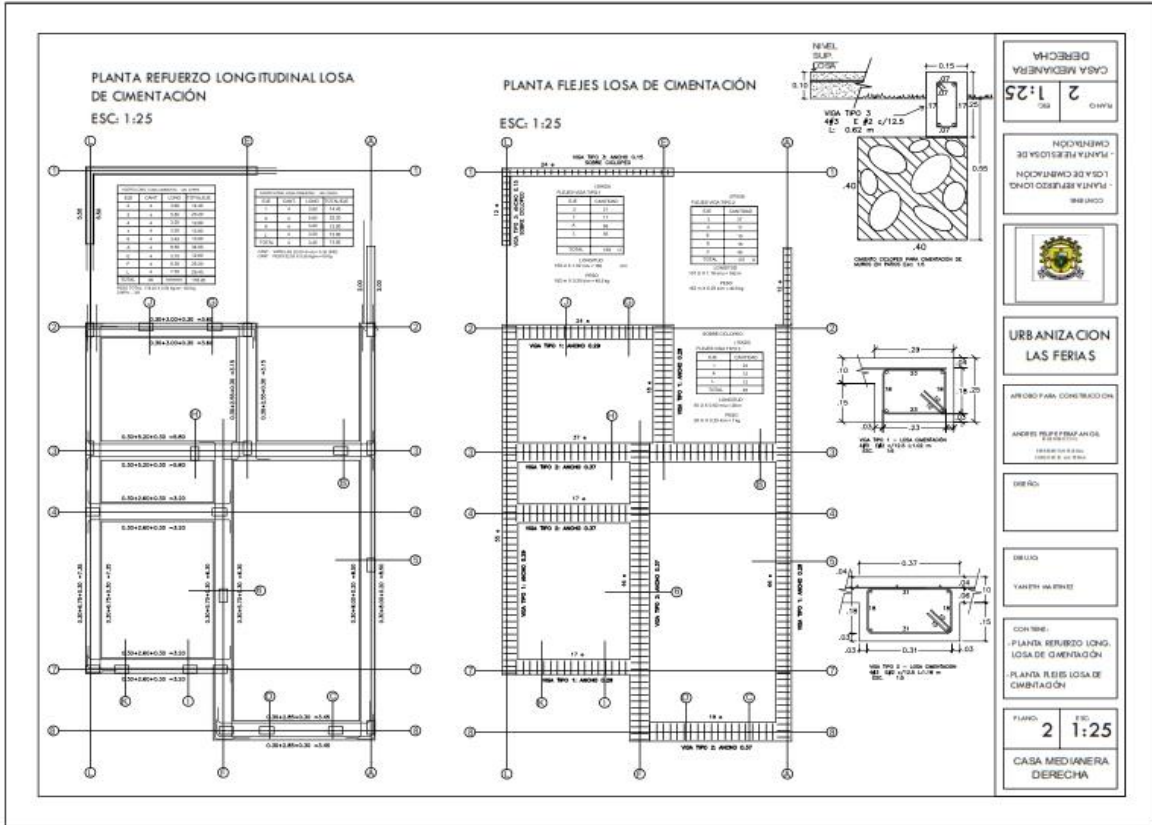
Planta refuerzo longitudinal losa de cimentación, flejes losa de cimentación.
